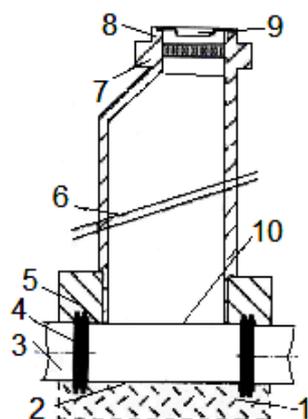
Провод трубы «КОРСИС ПРО» через стенку бетонного прямоугольного колодца
